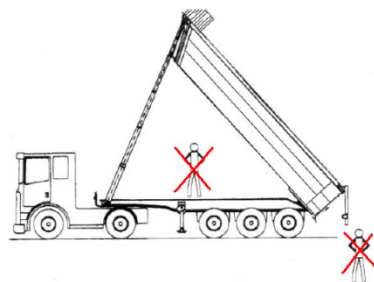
No situarse bajo la carrocería o en la zona de trabajo
